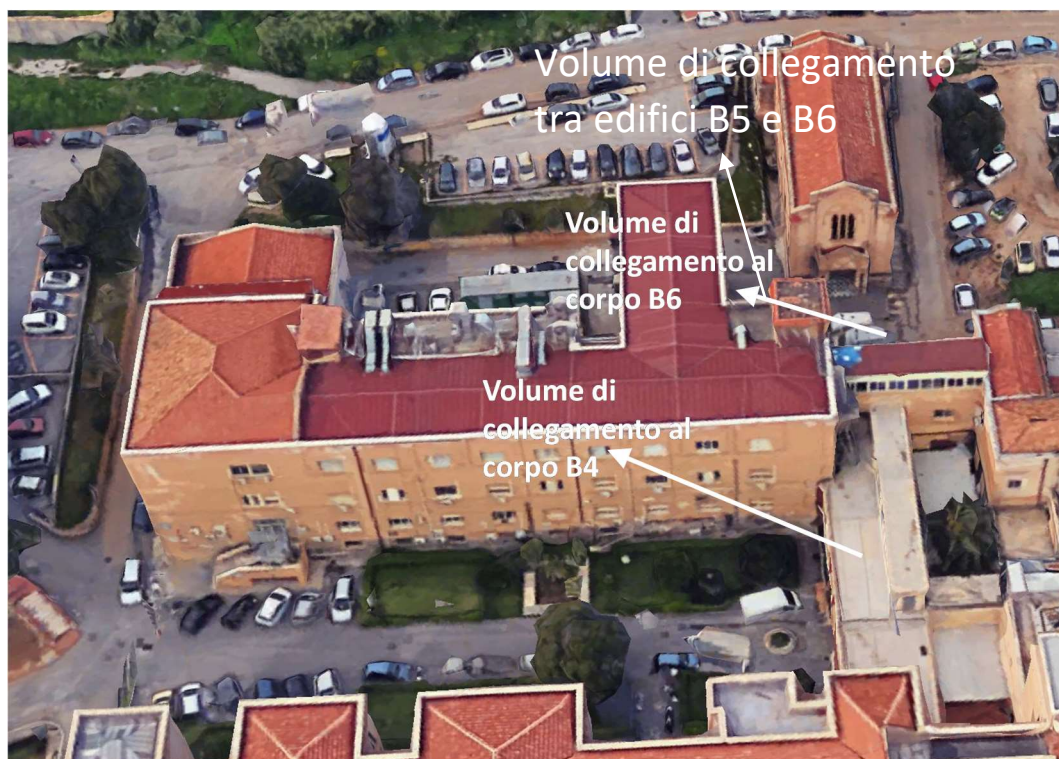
Vista dell'edificio B5 con particolare del volume di collegamento all'edificio B6.
